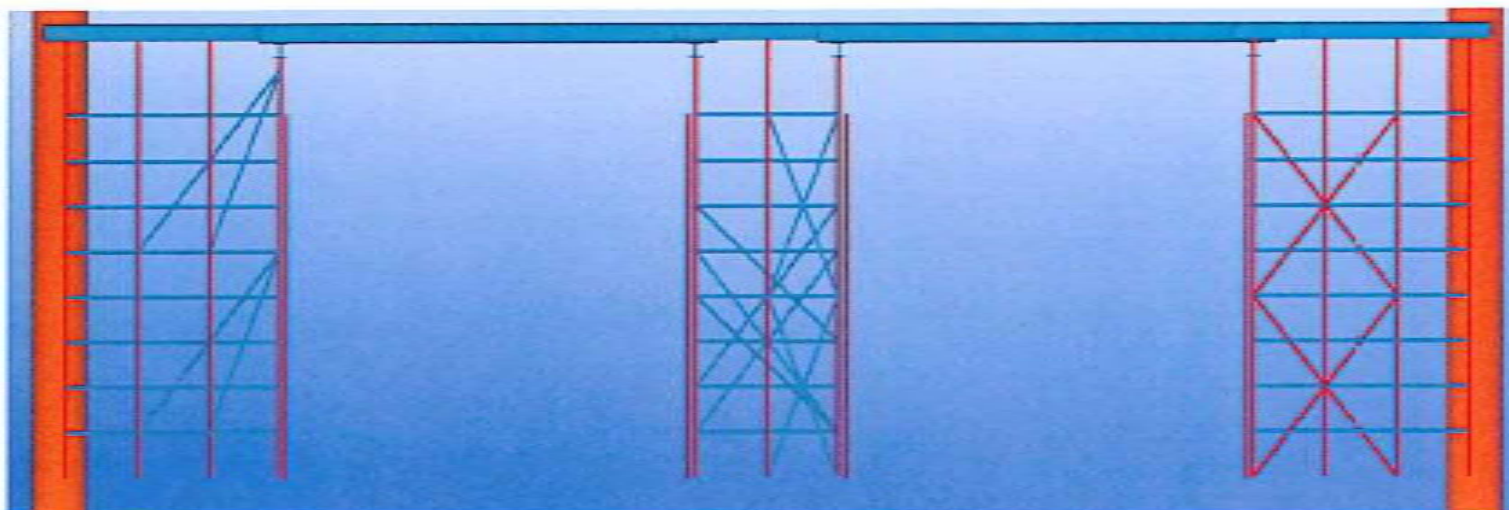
Rotvollhaugen bru sør – plan med eksisterende bru.
